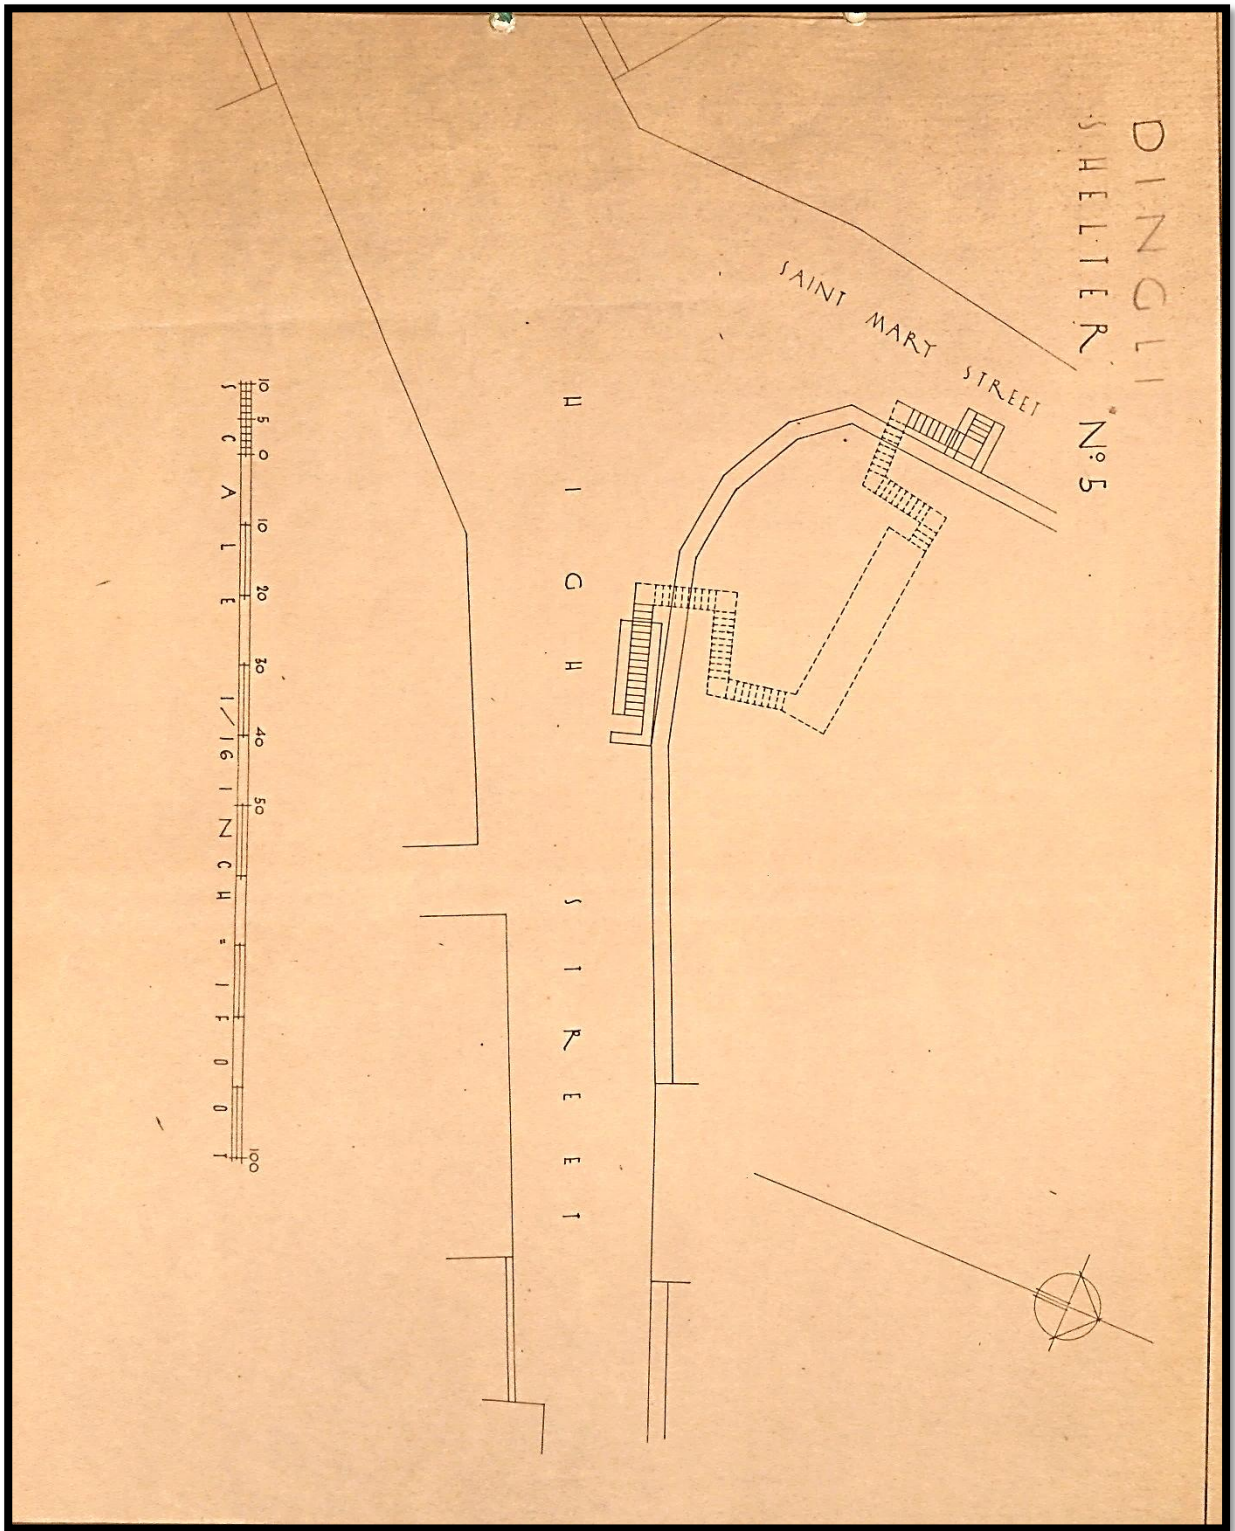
Planta do Abrigo nº 5 "Saint Mary Street – High Street."
